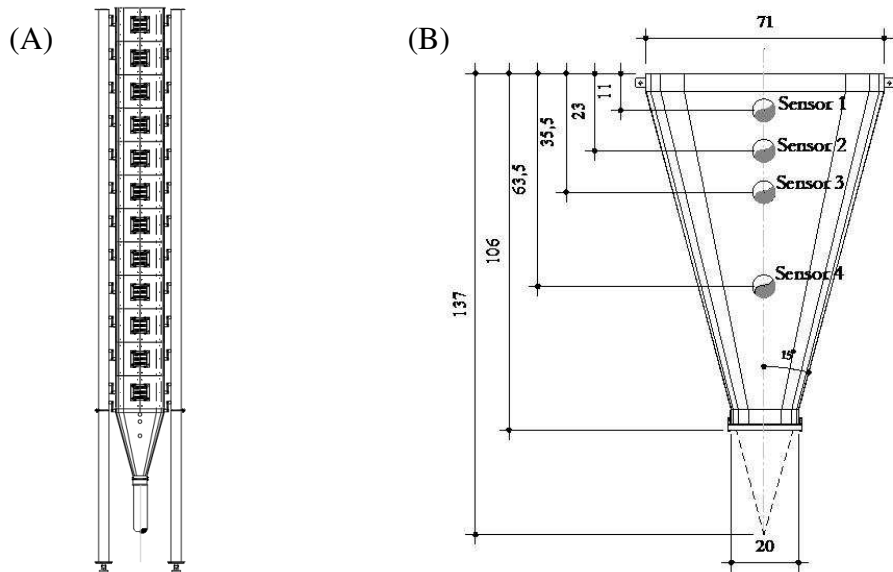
Vista esquemática geral do silo piloto (A) e detalhe da tremonha (B).
